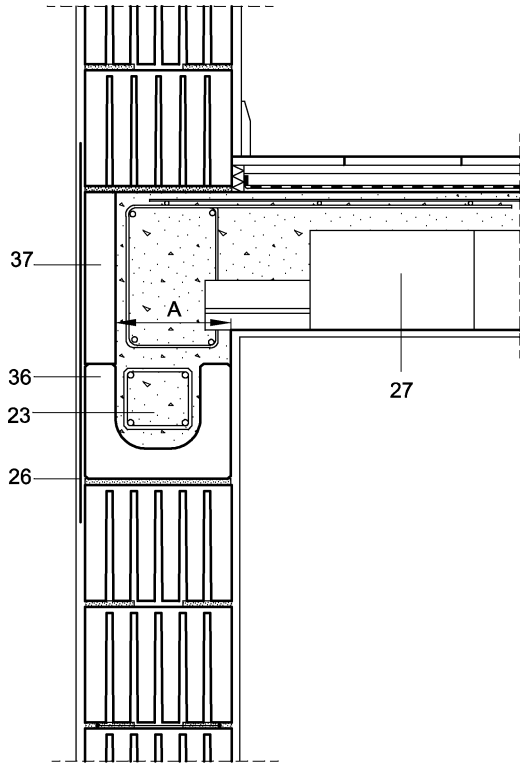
Encuentro con forjado. Muro portante exterior.
